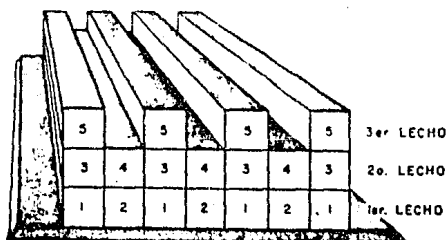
SECUENCIA DE COLADO DE PILOTES DE SECCION CUADRADA.
